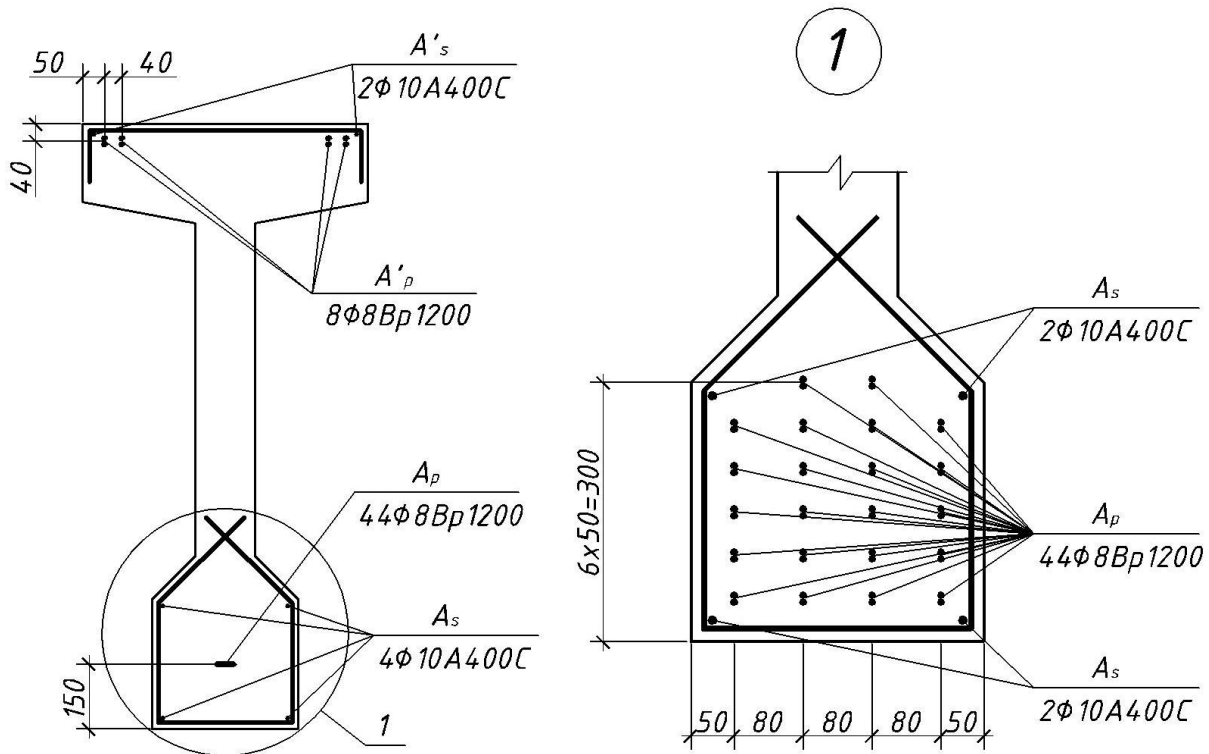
Розміщення поздовжньої арматури в перерізі підкранової балки
